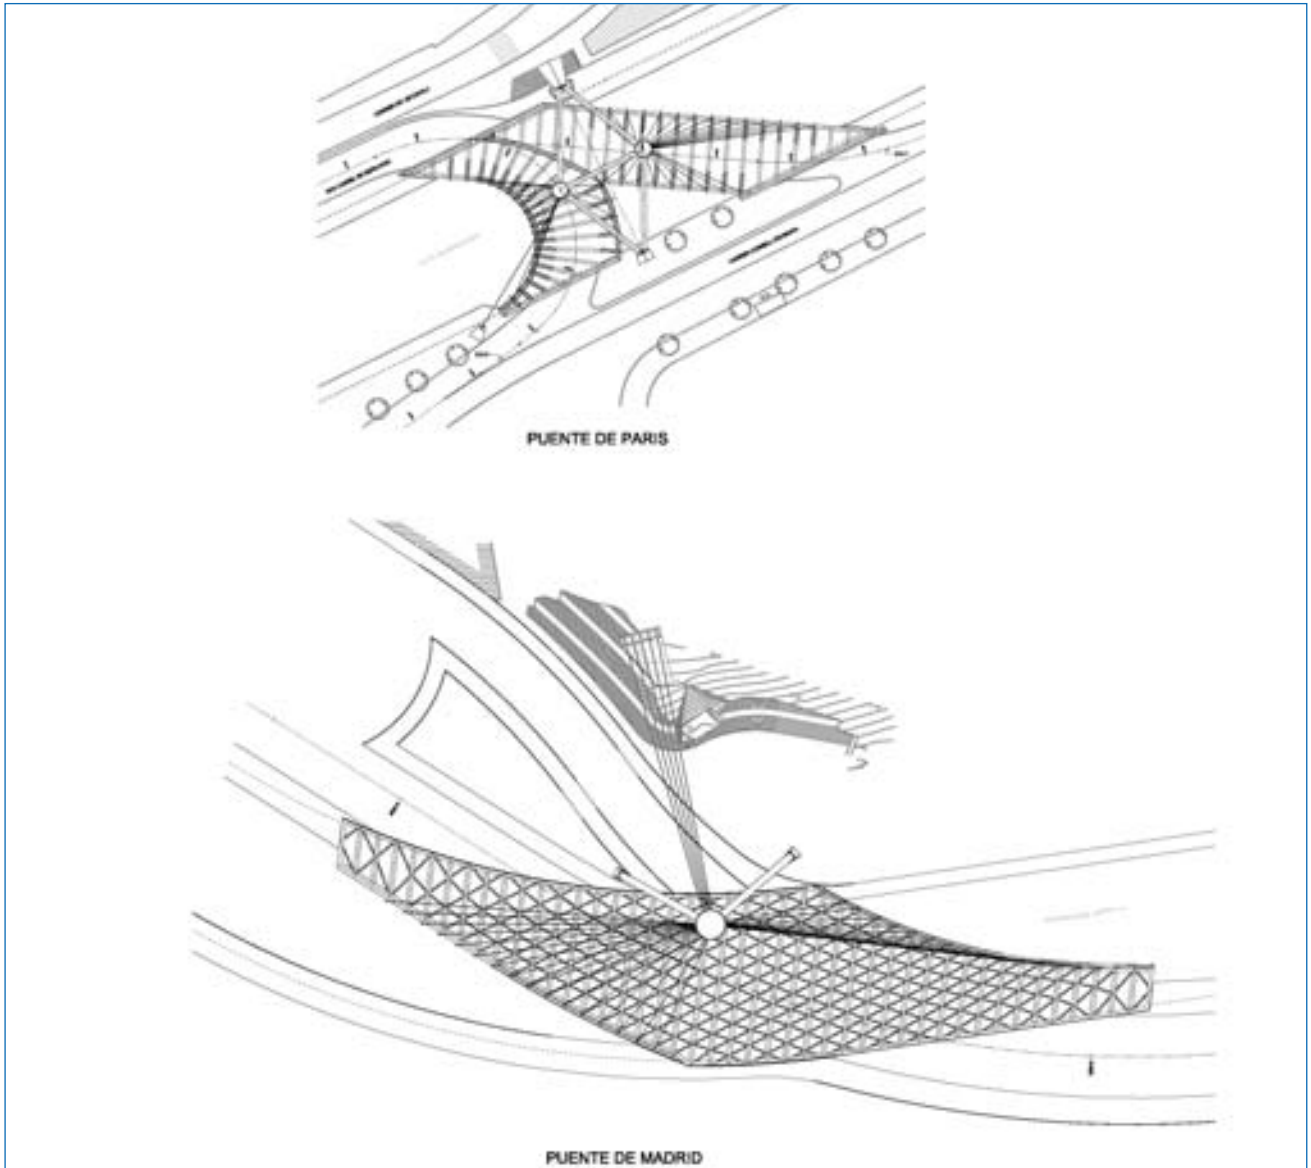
Plantas de las estructuras de los puentes de París y de Madrid.
